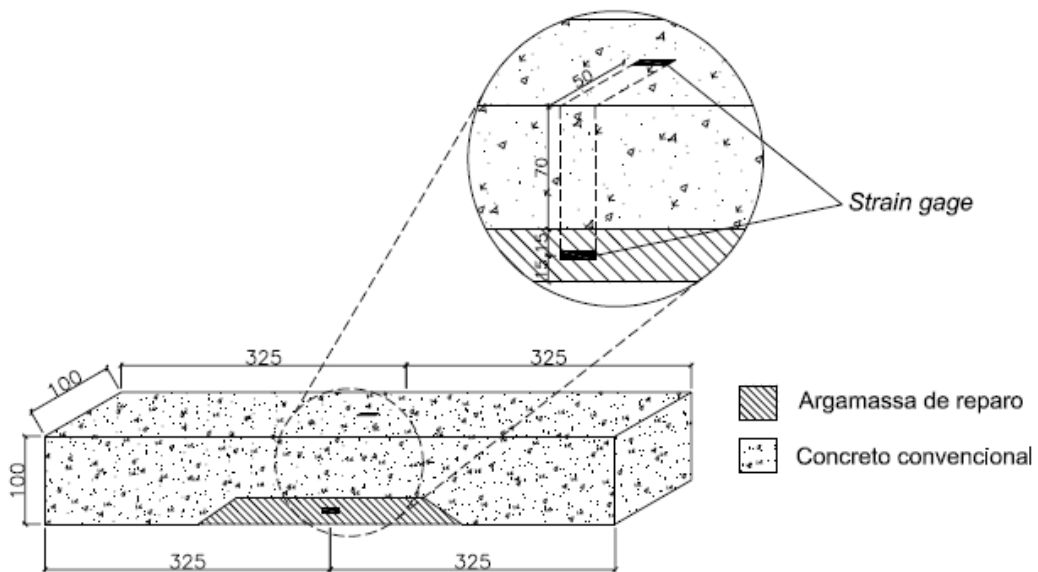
Posicionamento dos extensômetros elétricos de resistência nas vigas (dimensões em mm).
